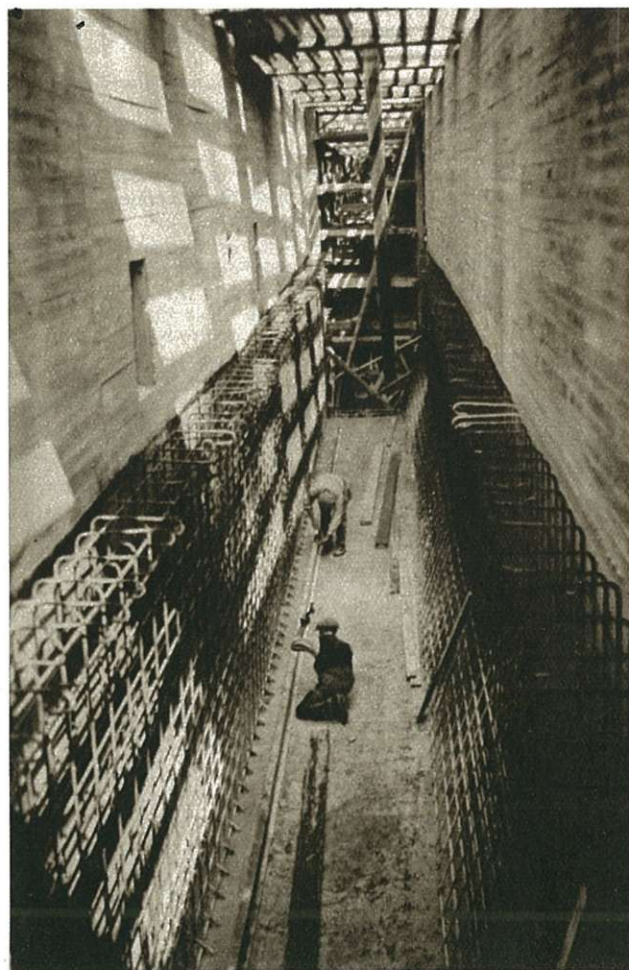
Pose du ferrailage de l'égout collecteur — 1er tronçon.
